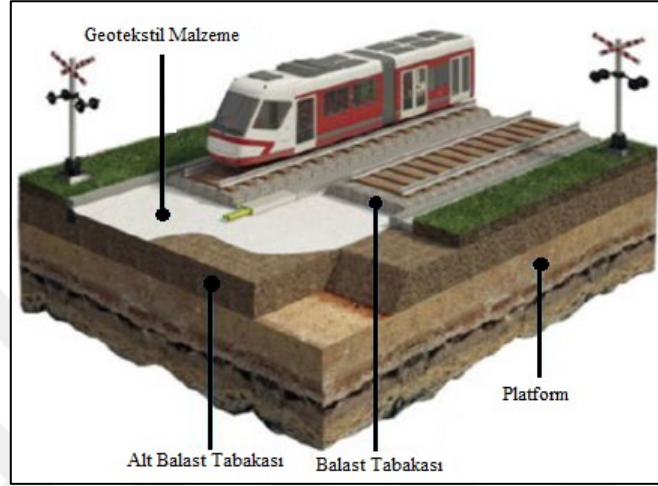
Balast yenilemede geotekstil kullanımı
